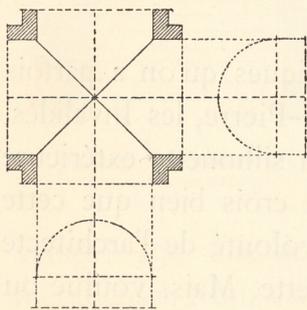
Voûte d'arête cylindrique sur plan carré.
